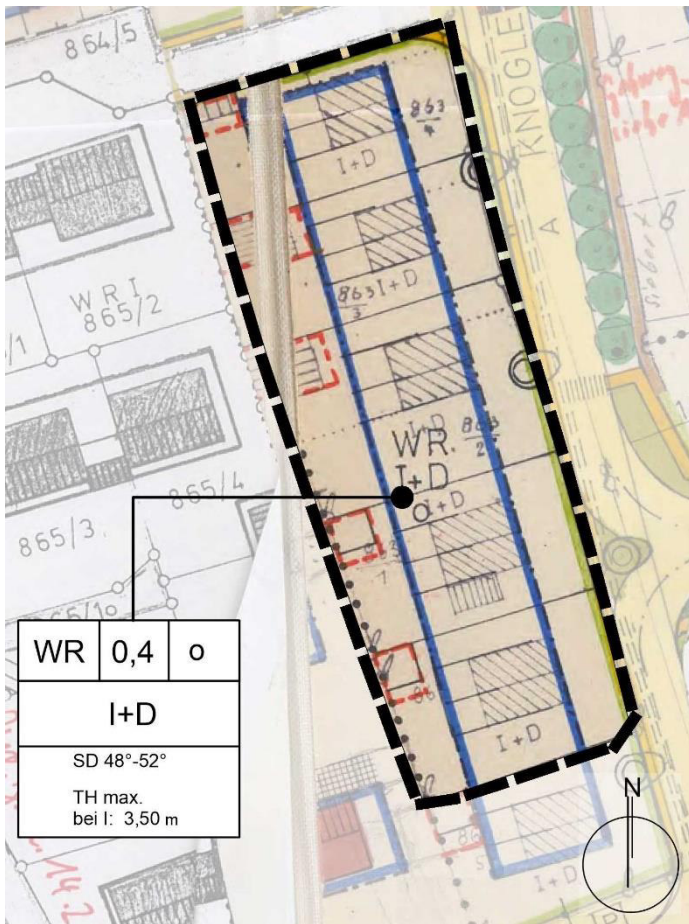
rechtskräftiger Bebauungsplan „Krautgärten“ von 1977 mit markiertem Ausschnitt der 11. Änderung, ohne Maßstab
